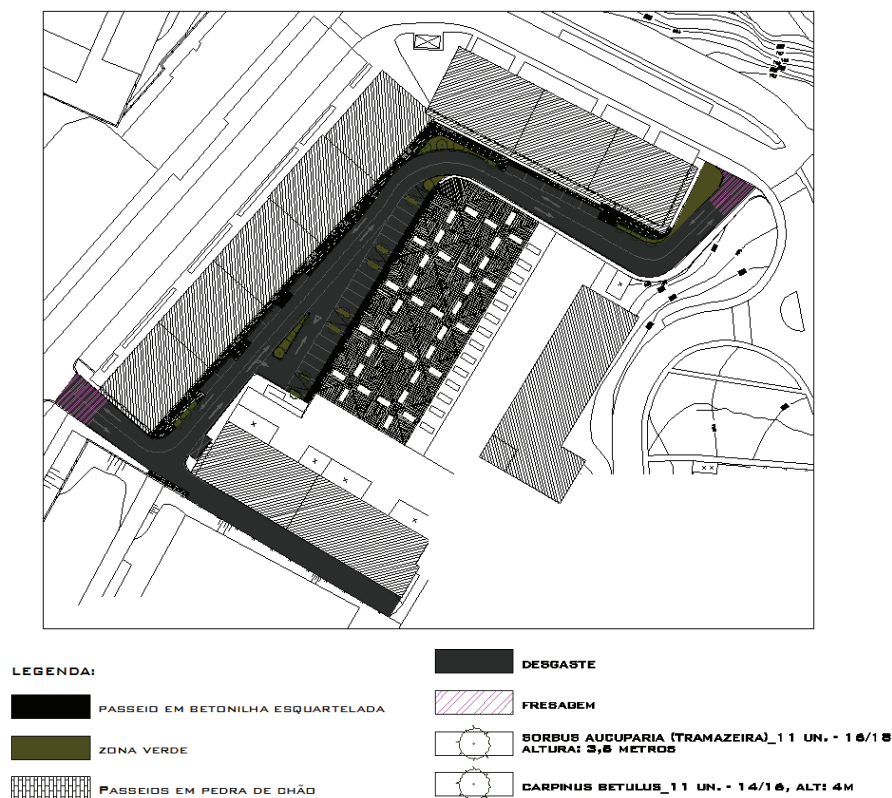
Planta de trabalhos Travessa Teixeira de Pascoais e Travessa Ferreira de Castro.
